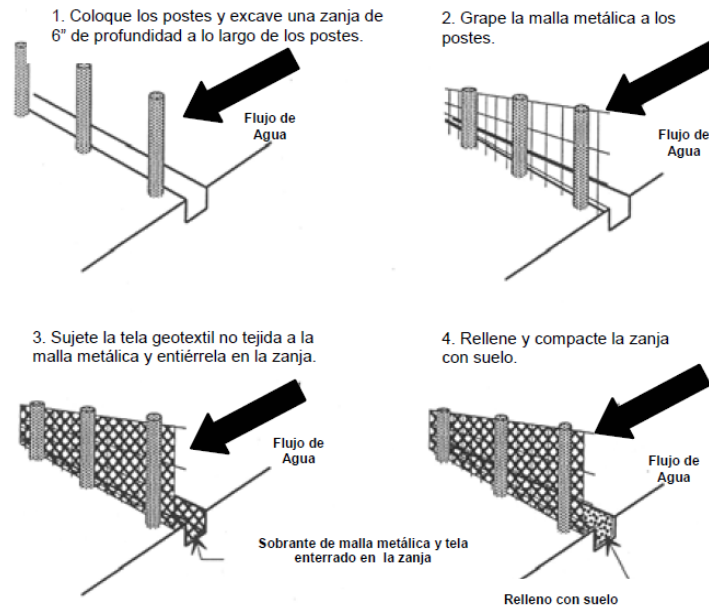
Ejemplo de la Instalación de barreras de cieno.
